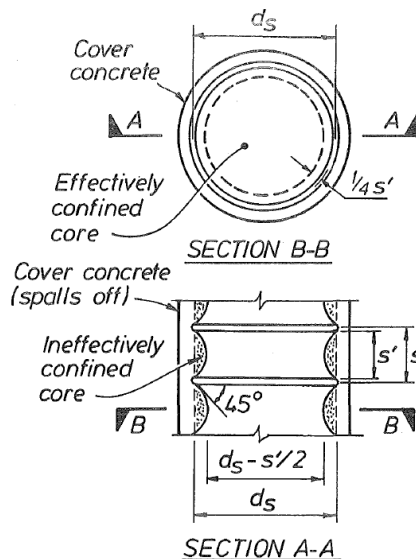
Sezione di calcestruzzo effettivamente confinata con staffe
